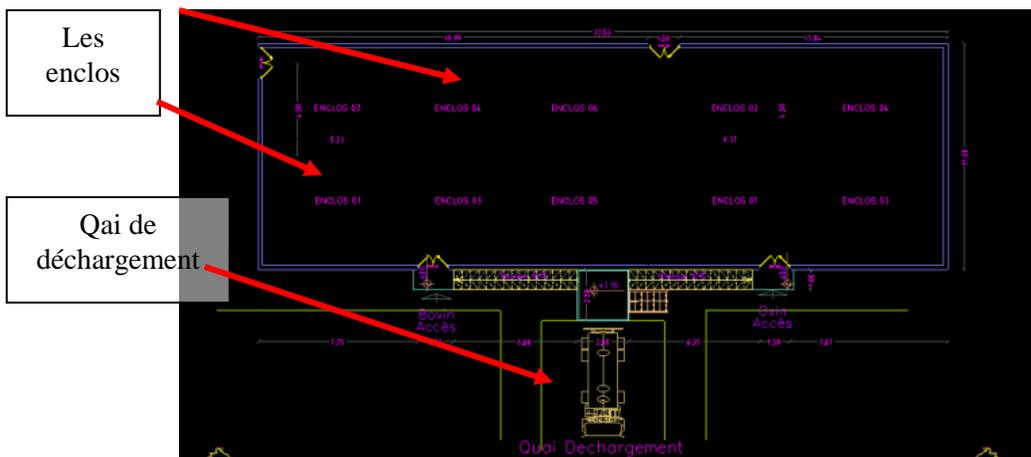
le plan plus détaillé du parc d'attente de notre abattoir.
